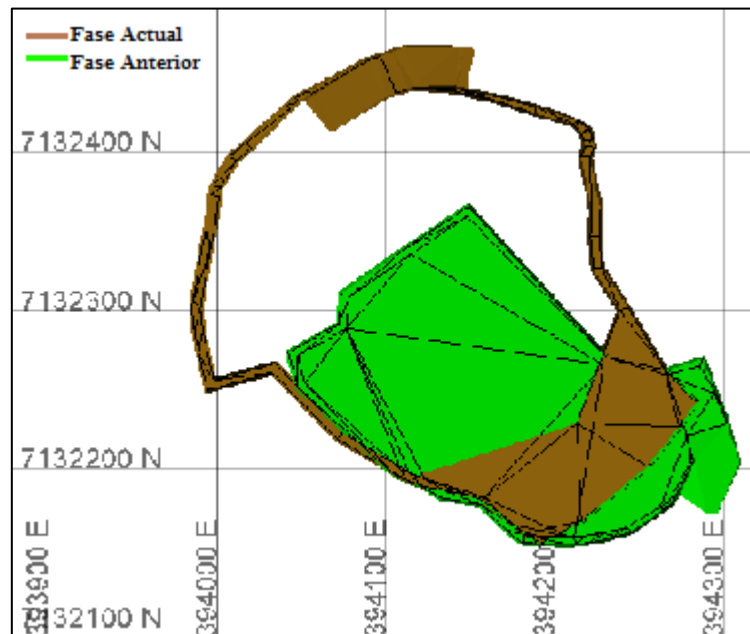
LGMMIY Fase 5 - Vista en sección - Planta banco 1030
